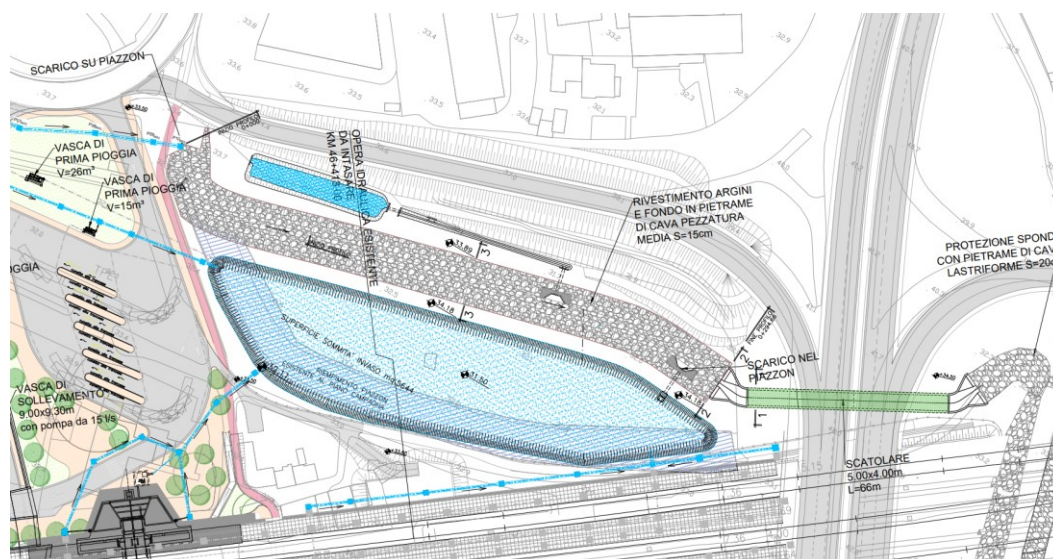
Deviazione planimetrica del Piazzon ed area di laminazione
